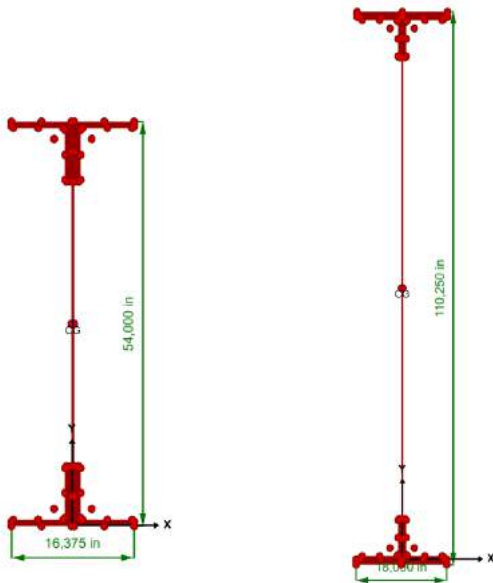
Coupes sectionnelles des poutres principales de 45' (gauche) et 90' de long (droite)
